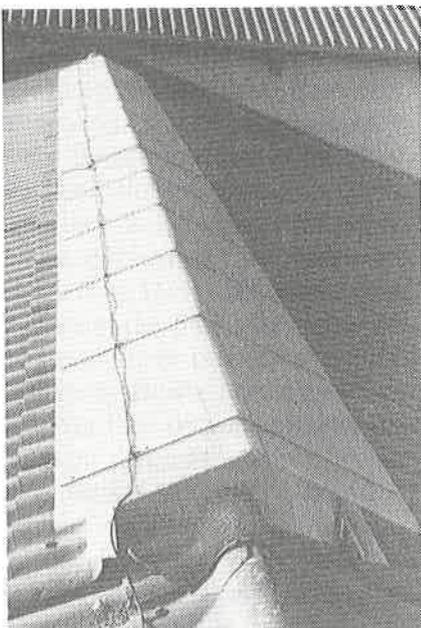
Surtoiture transparente recouvrant la fente de faîte, à 15 cm au-dessus du toit, sans chasse-vent. Le clapet d'étranglement à l'intérieur de la fente de faîte est également transparent.
